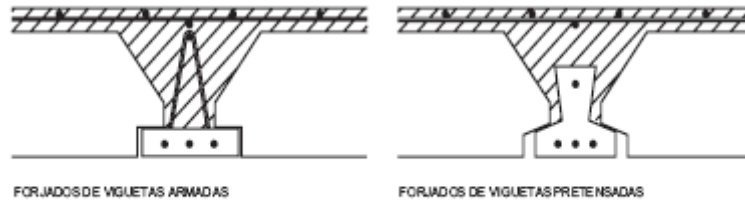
Tipos usuales de forjados de viguetas
